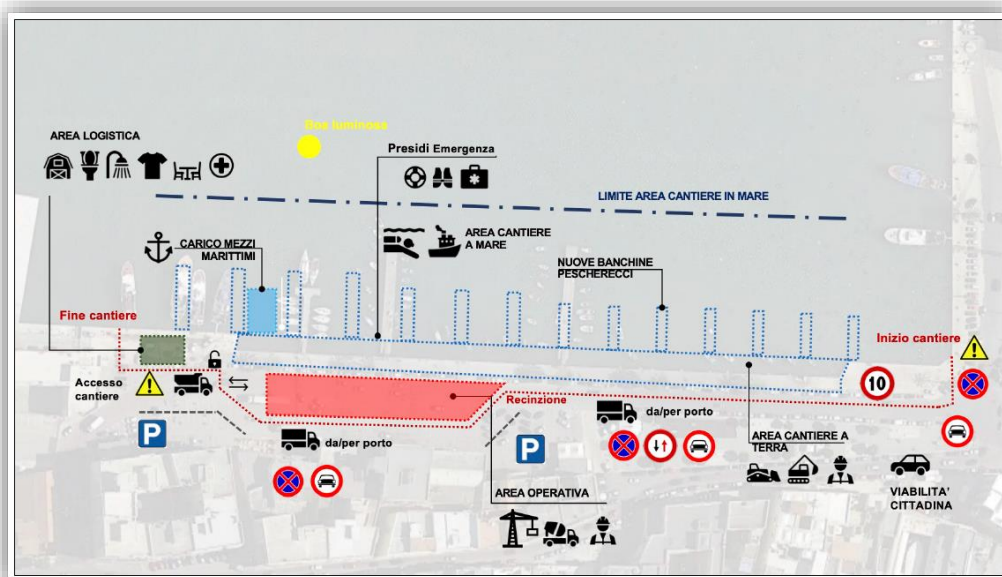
Dettaglio area di cantiere "Banchina San Domenico"
